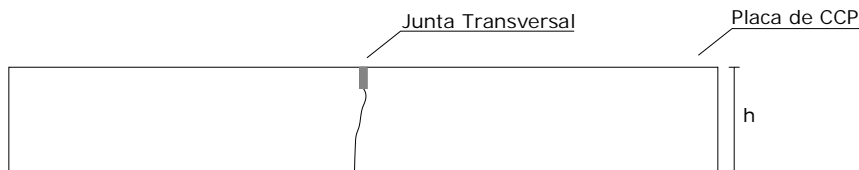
Juntas transversais serradas em pavimentos de Concreto de Cimento Portland (CCP), em corte.
